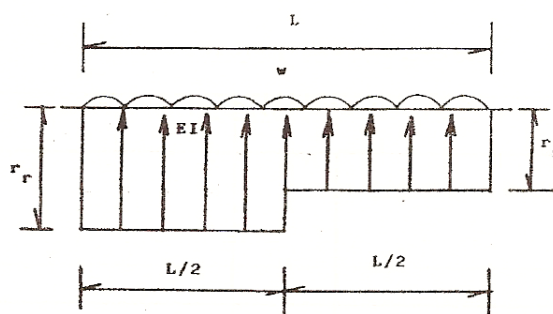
Geometría y cargas de la barra de cimentación.
